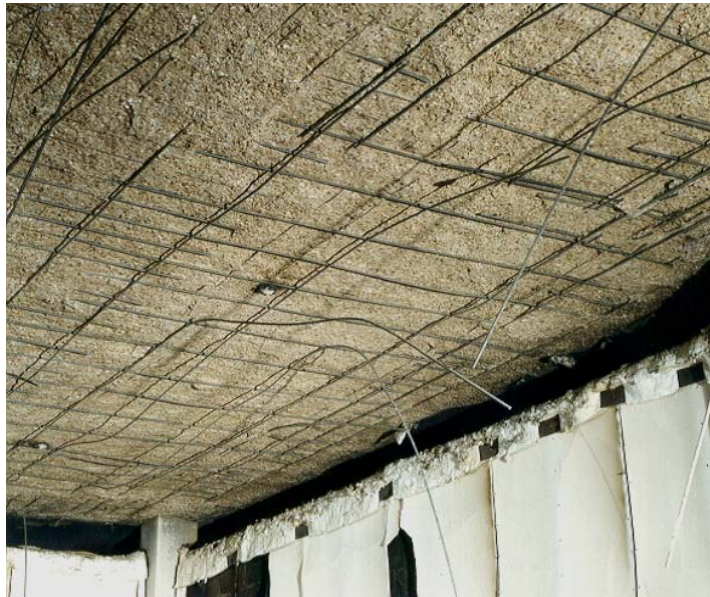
Laje de concreto armado do ensaio em escala real em Cardington ((BAILEY, 2002) *apud* (COSTA, 2008)).
